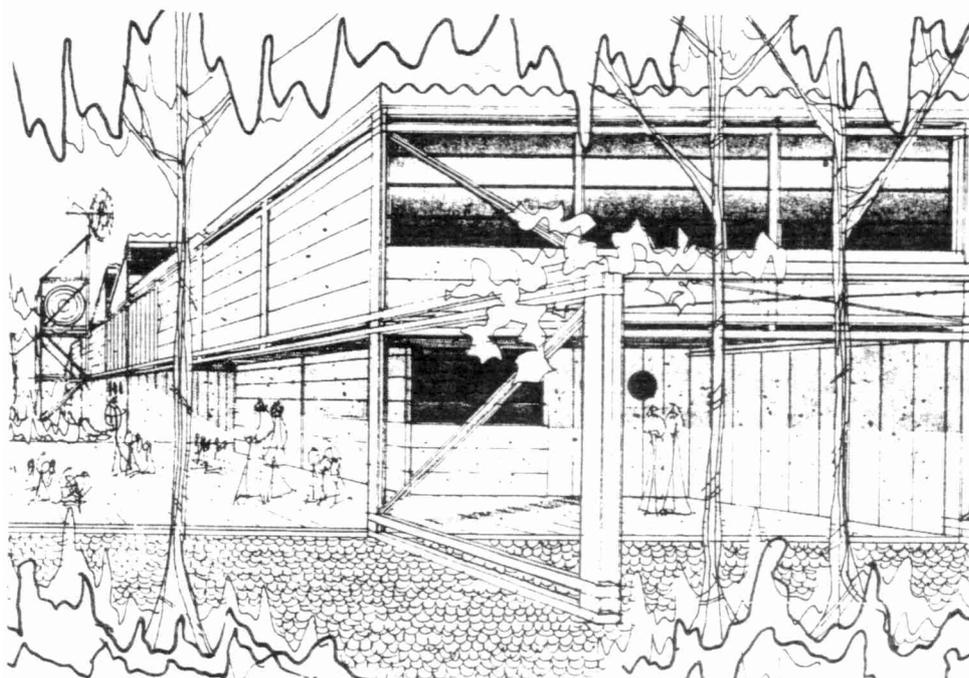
Projeto de sistema construtivo em estrutura de aço com crescimento horizontal - Menção Honrosa (Arquiteto Joel Campolina e Associados)
